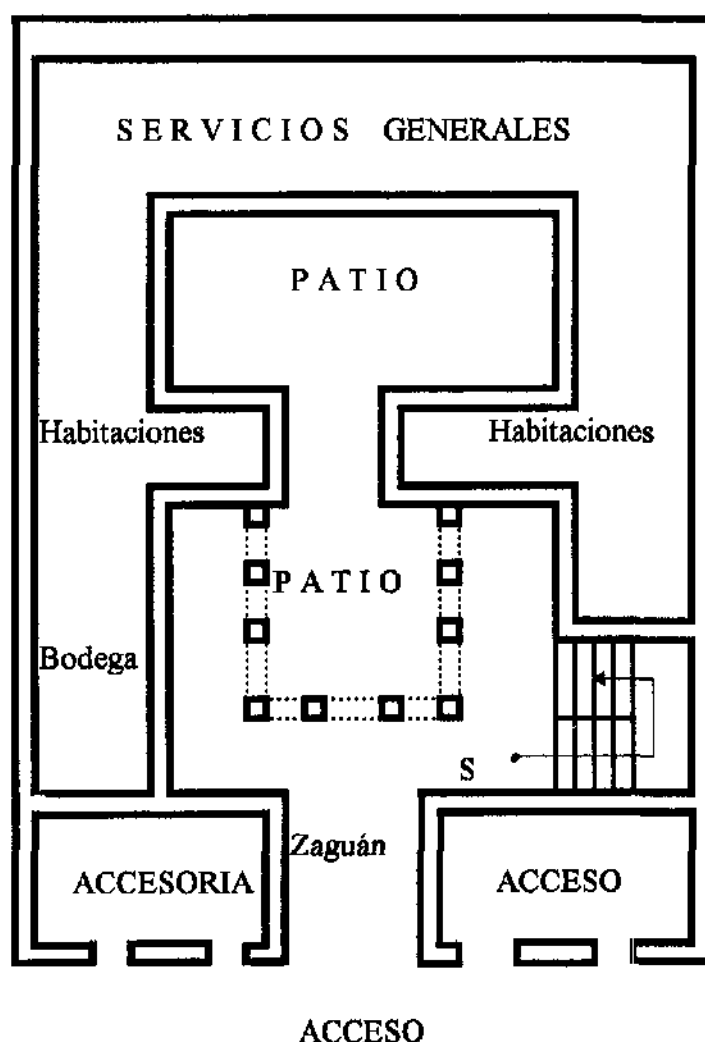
ESQUEMA DE LA CASA SEÑORIAL Planta baja
